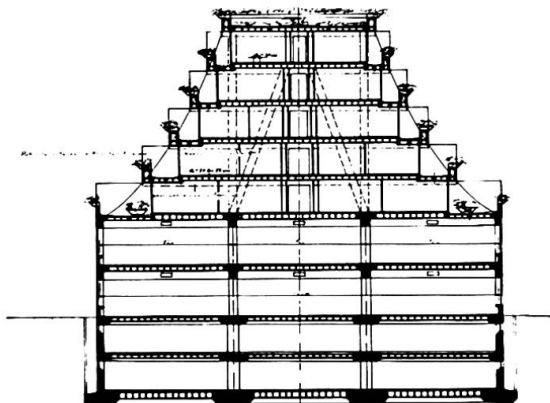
Steilwandiges Gebäude mit oberem Terrassen-aufbau.
